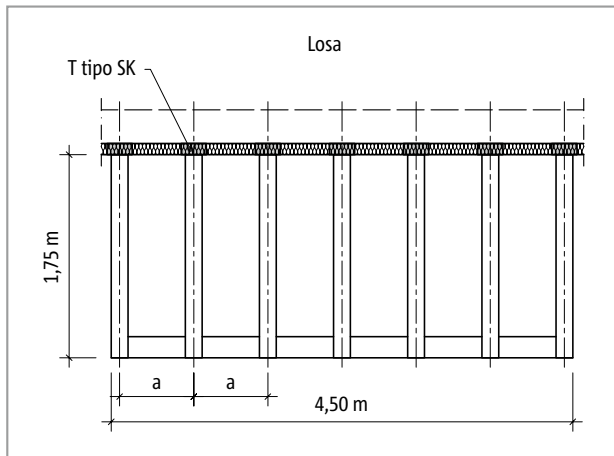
Schöck Isokorb® T tipo SK: Plano
